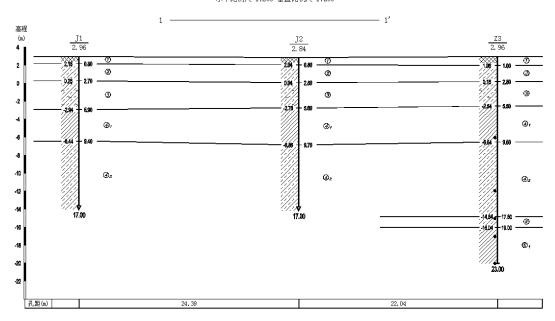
本项目拟建厂区地层岩性典型剖面图
